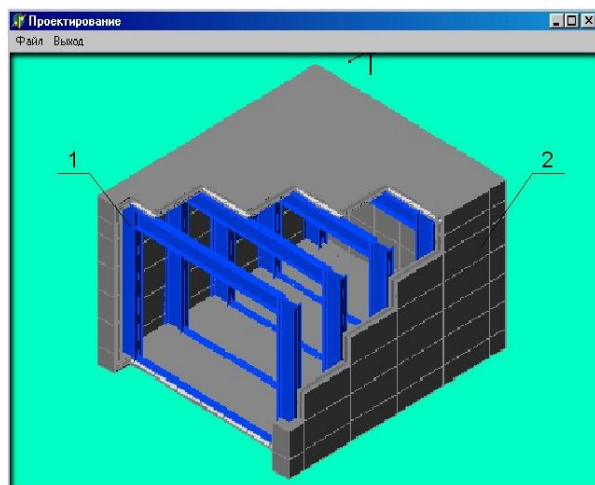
Схема сейфового помещения с ограждением из сборных сталефиброжелезобетонных элементов:
